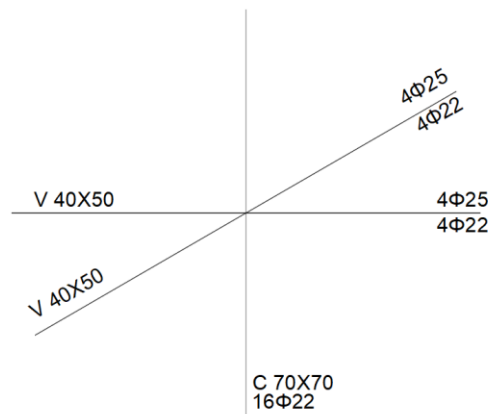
Ejemplo Nudo interior Planta Baja para chequeo de conexión viga - columna
